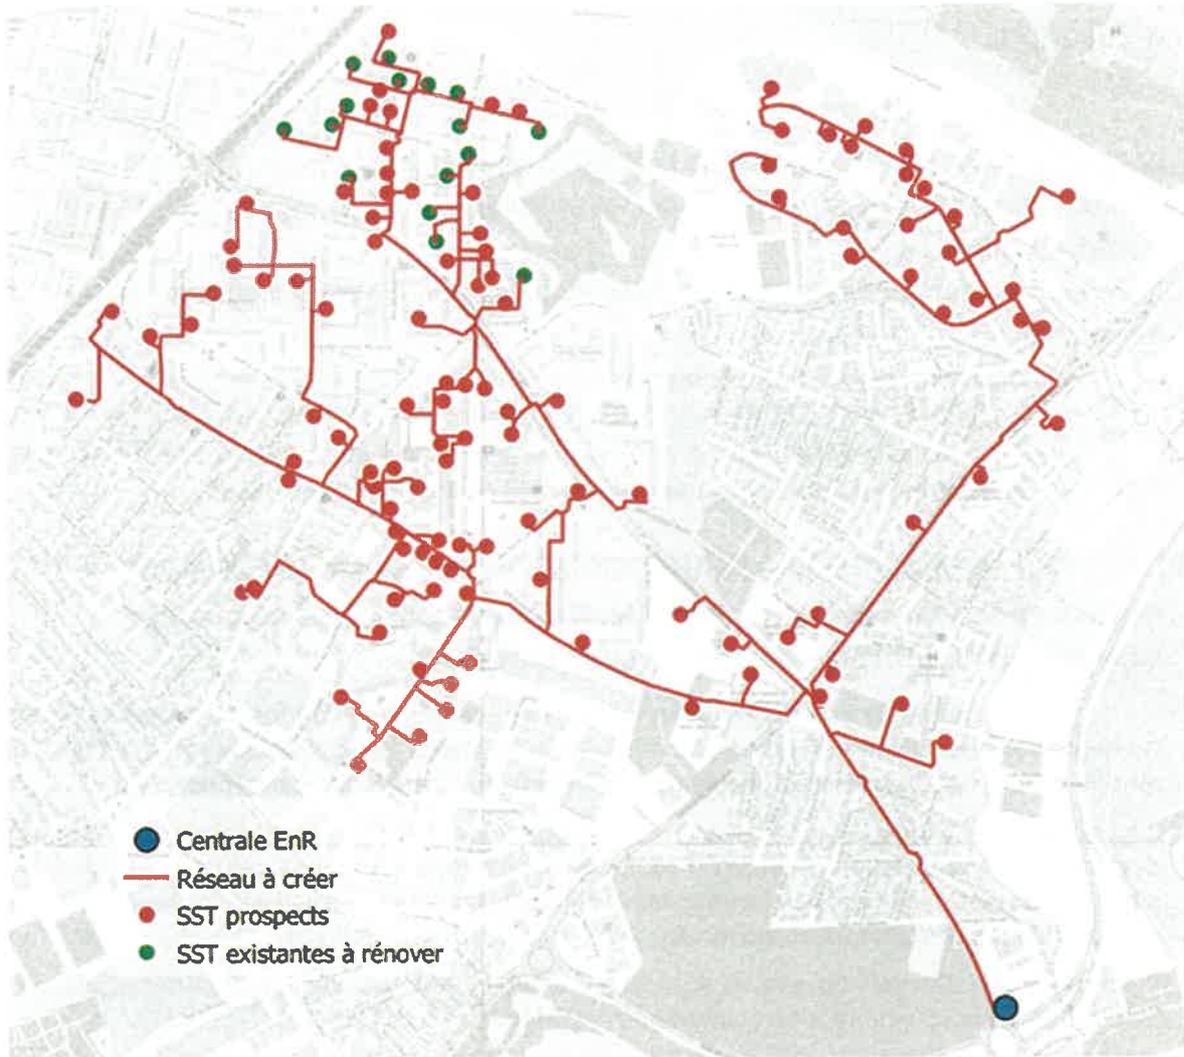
Plan du réseau de chaleur prévu à horizon 2028
